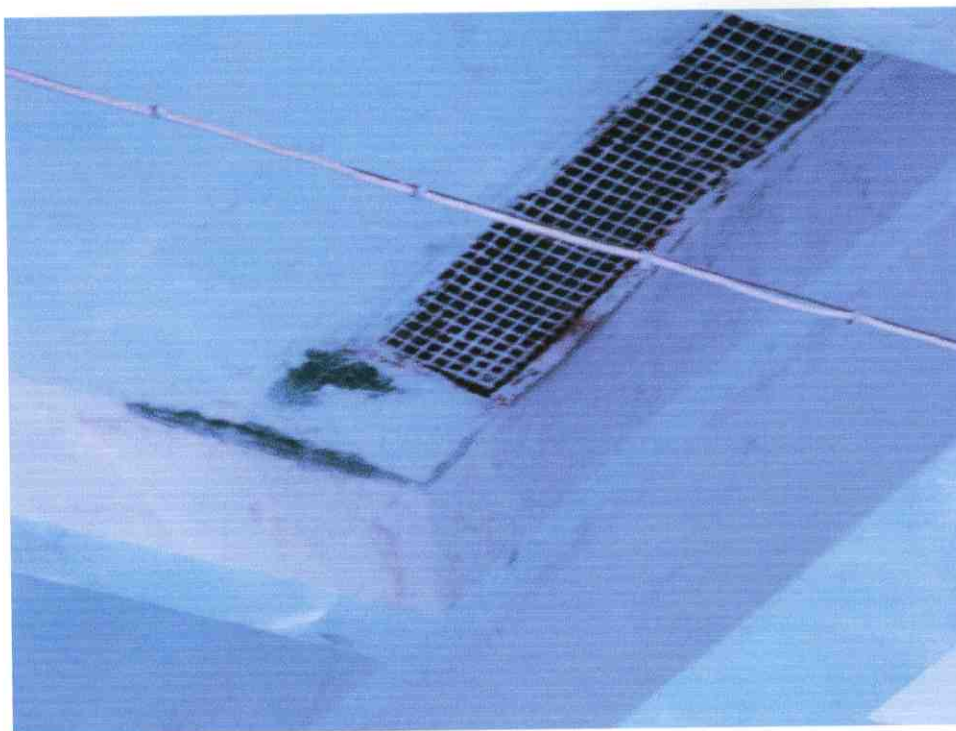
Widoczne zniszczenia stropodach spowodowane wilgocią.
